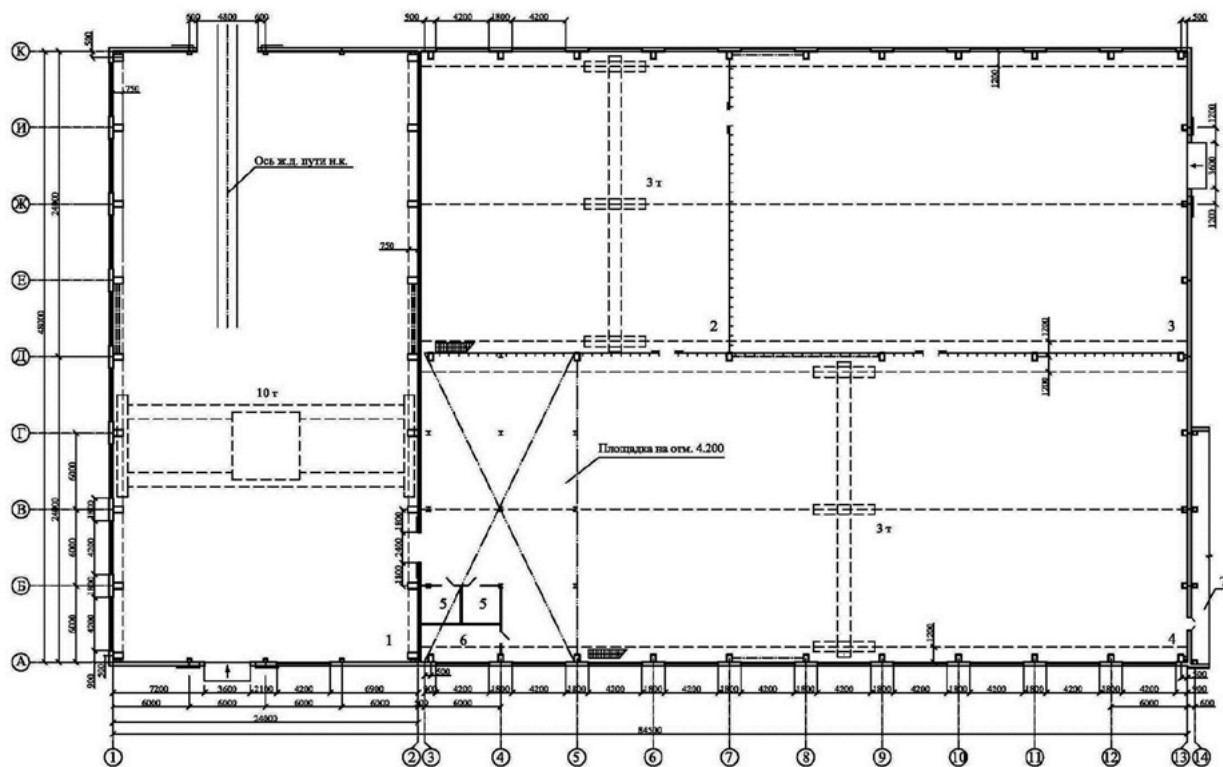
Пример плана производственного здания с железобетонными колоннами каркаса:
